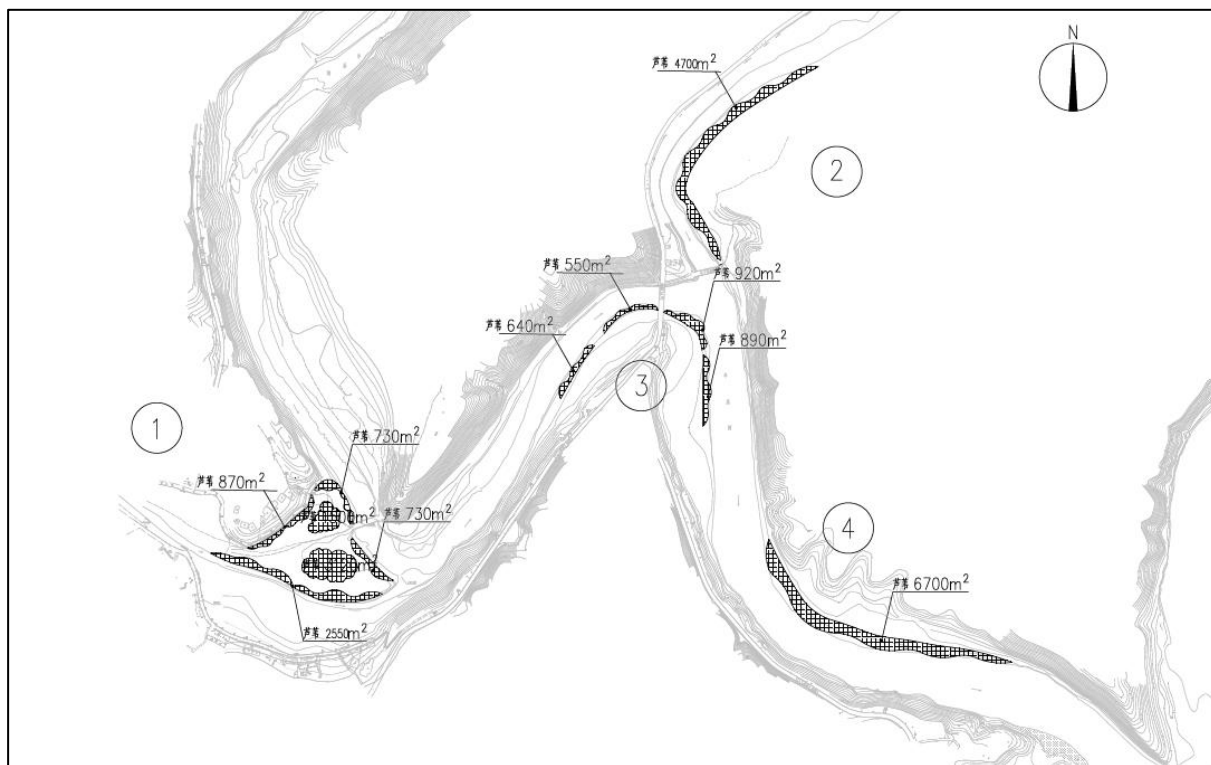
丰乐河、漕溪河河口水生植物总平面布置图
